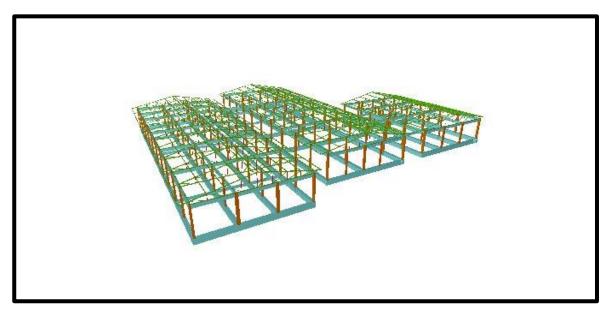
Estructura completa Fuente: CYPECAD v2016.n
